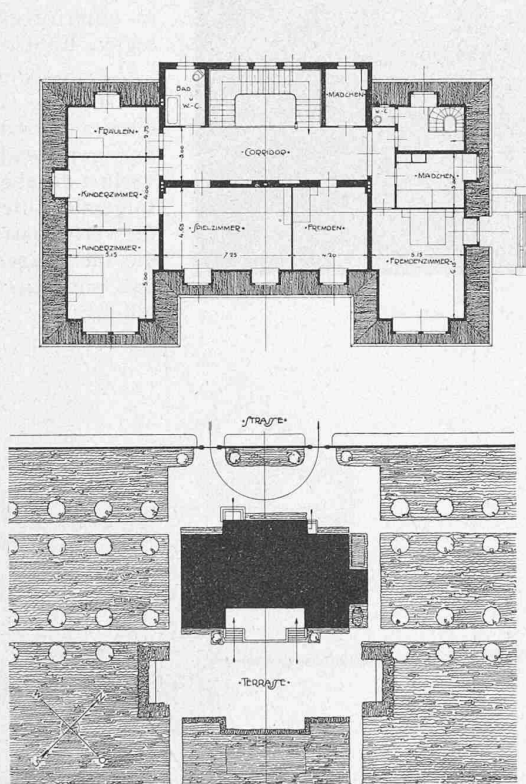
Lageplan 1 : 1000. — Landsitz von Prof. Henri Marteau. — Abb. 2 bis 4. Grundrisse 1 : 400.
